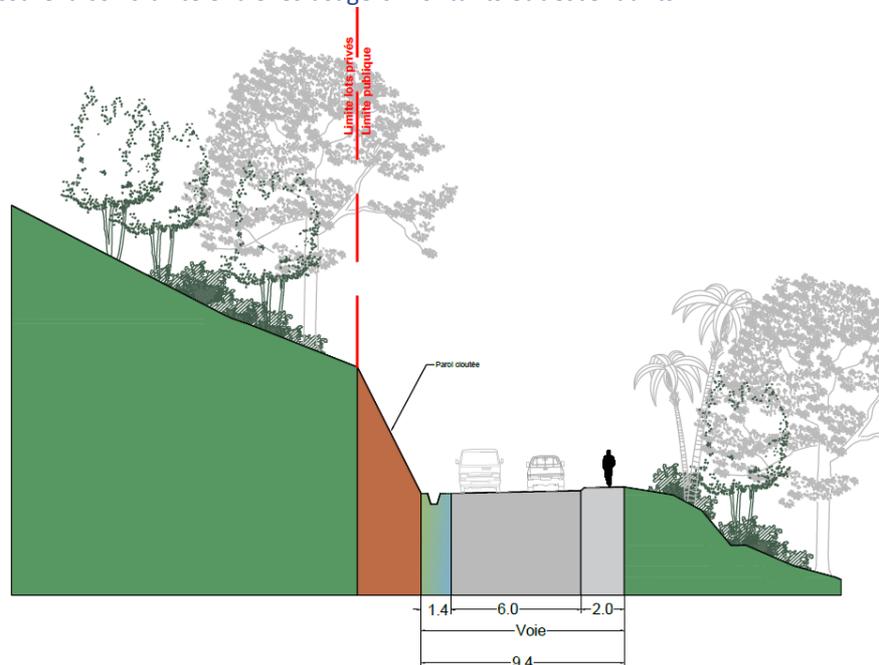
Profils en travers type de la route des crêtes (avec et sans stationnements)
